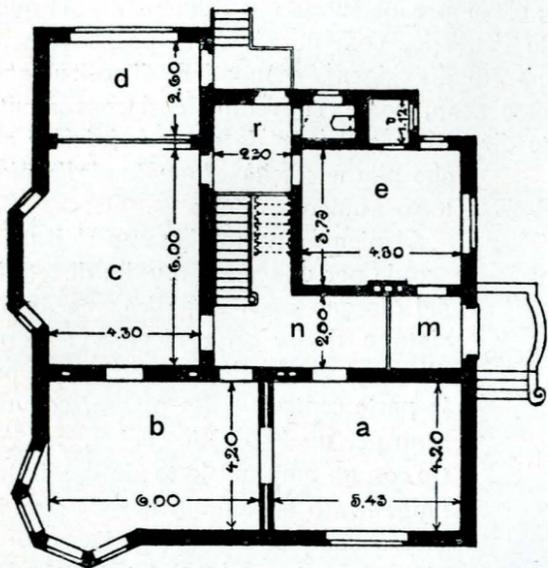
Pianta piano terreno - a salotto - b stanza soggiorno - c sala pranzo - d veranda - e cucina - m ingresso - n anticamera - r passaggio.
